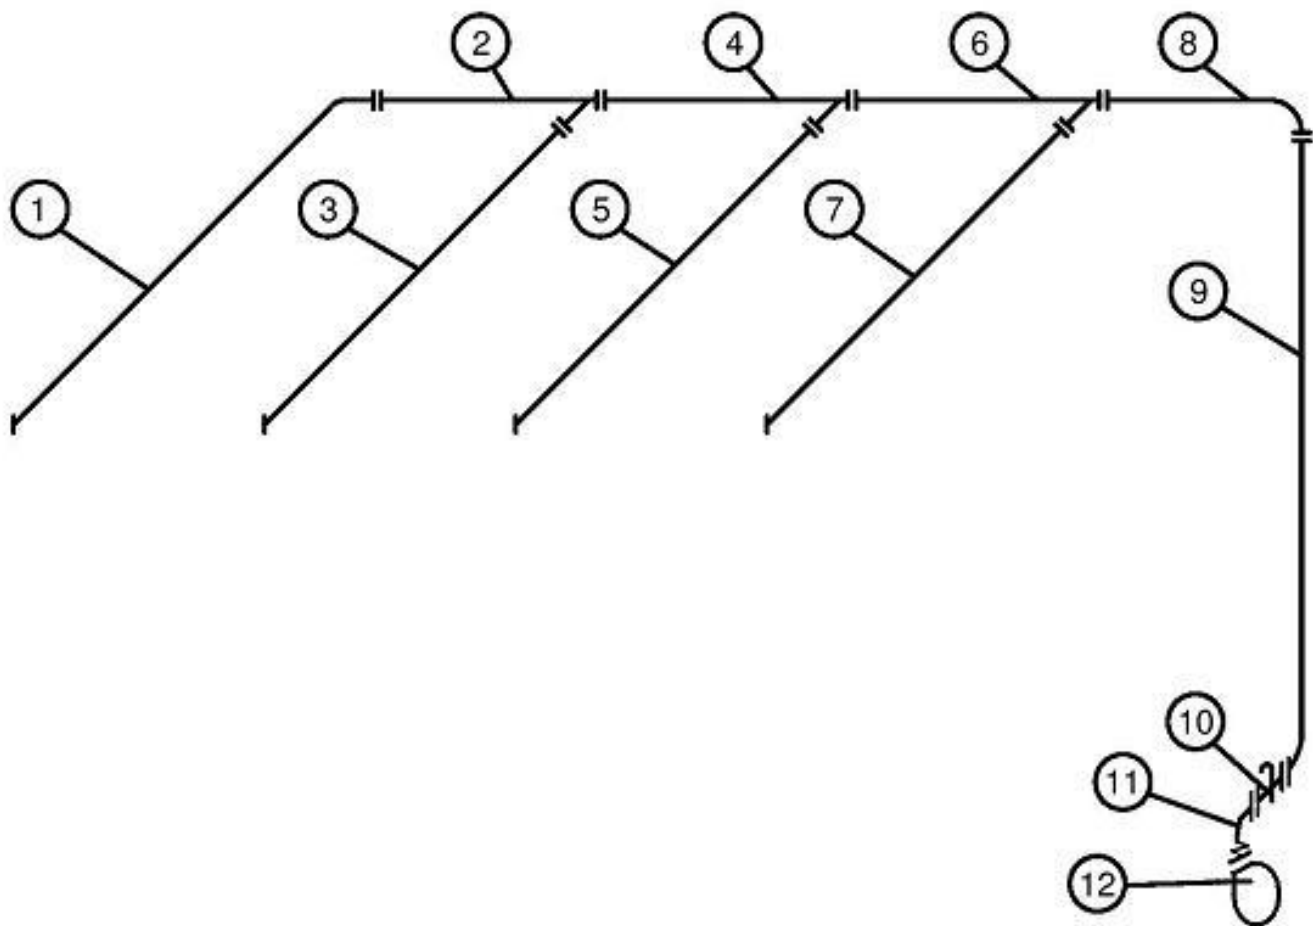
Схема разбивки на укрупненные узлы вентиляционной системы П1
